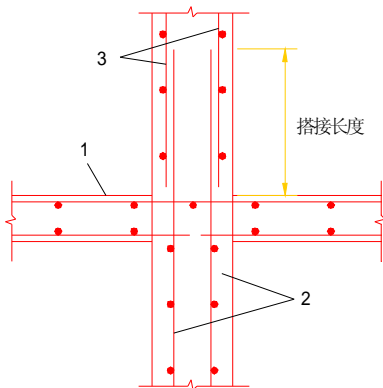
钢筋焊接网的竖向搭接
